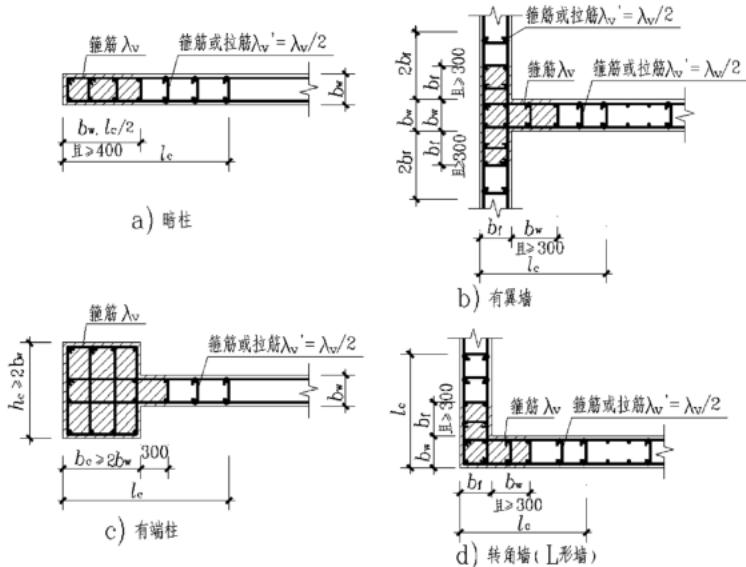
预制剪力墙的后浇混凝土约束边缘构件示意
